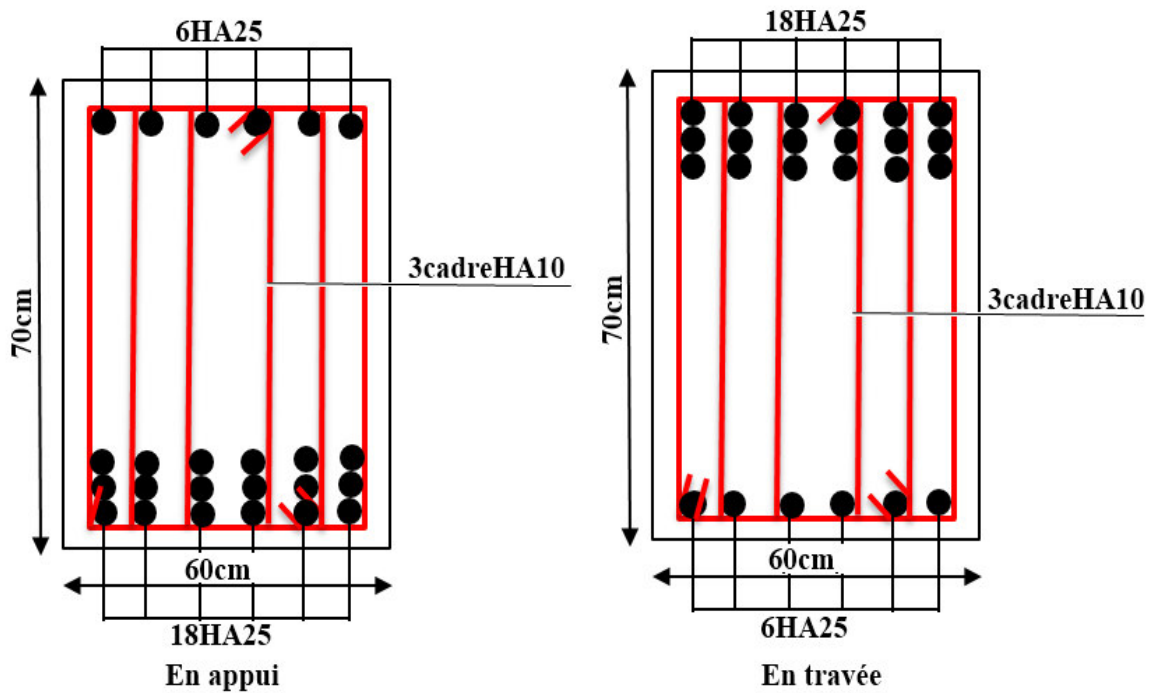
Schéma de ferrailage des nervures (y-y).
